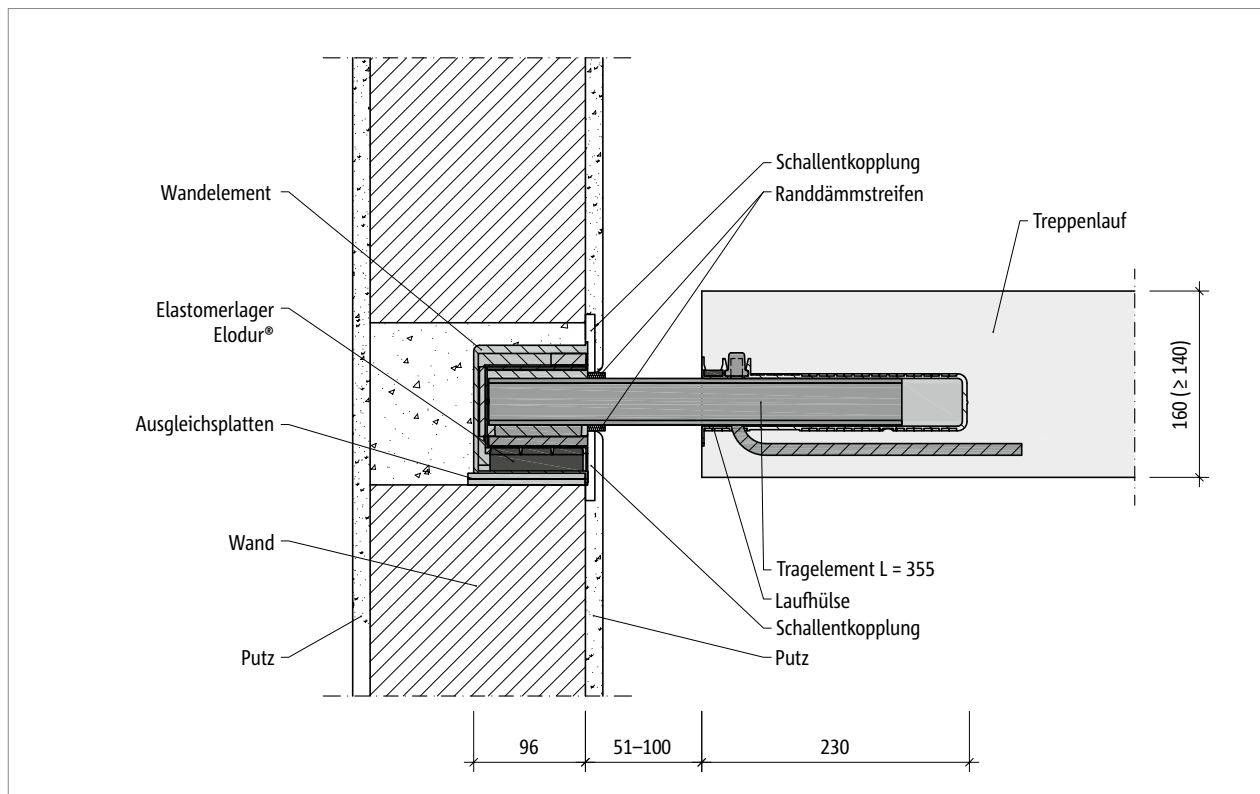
Schöck Tronsole® Typ Q-FV-XL oder Q-A2-XL: Einbauschnitt mit Elementtreppenlauf
